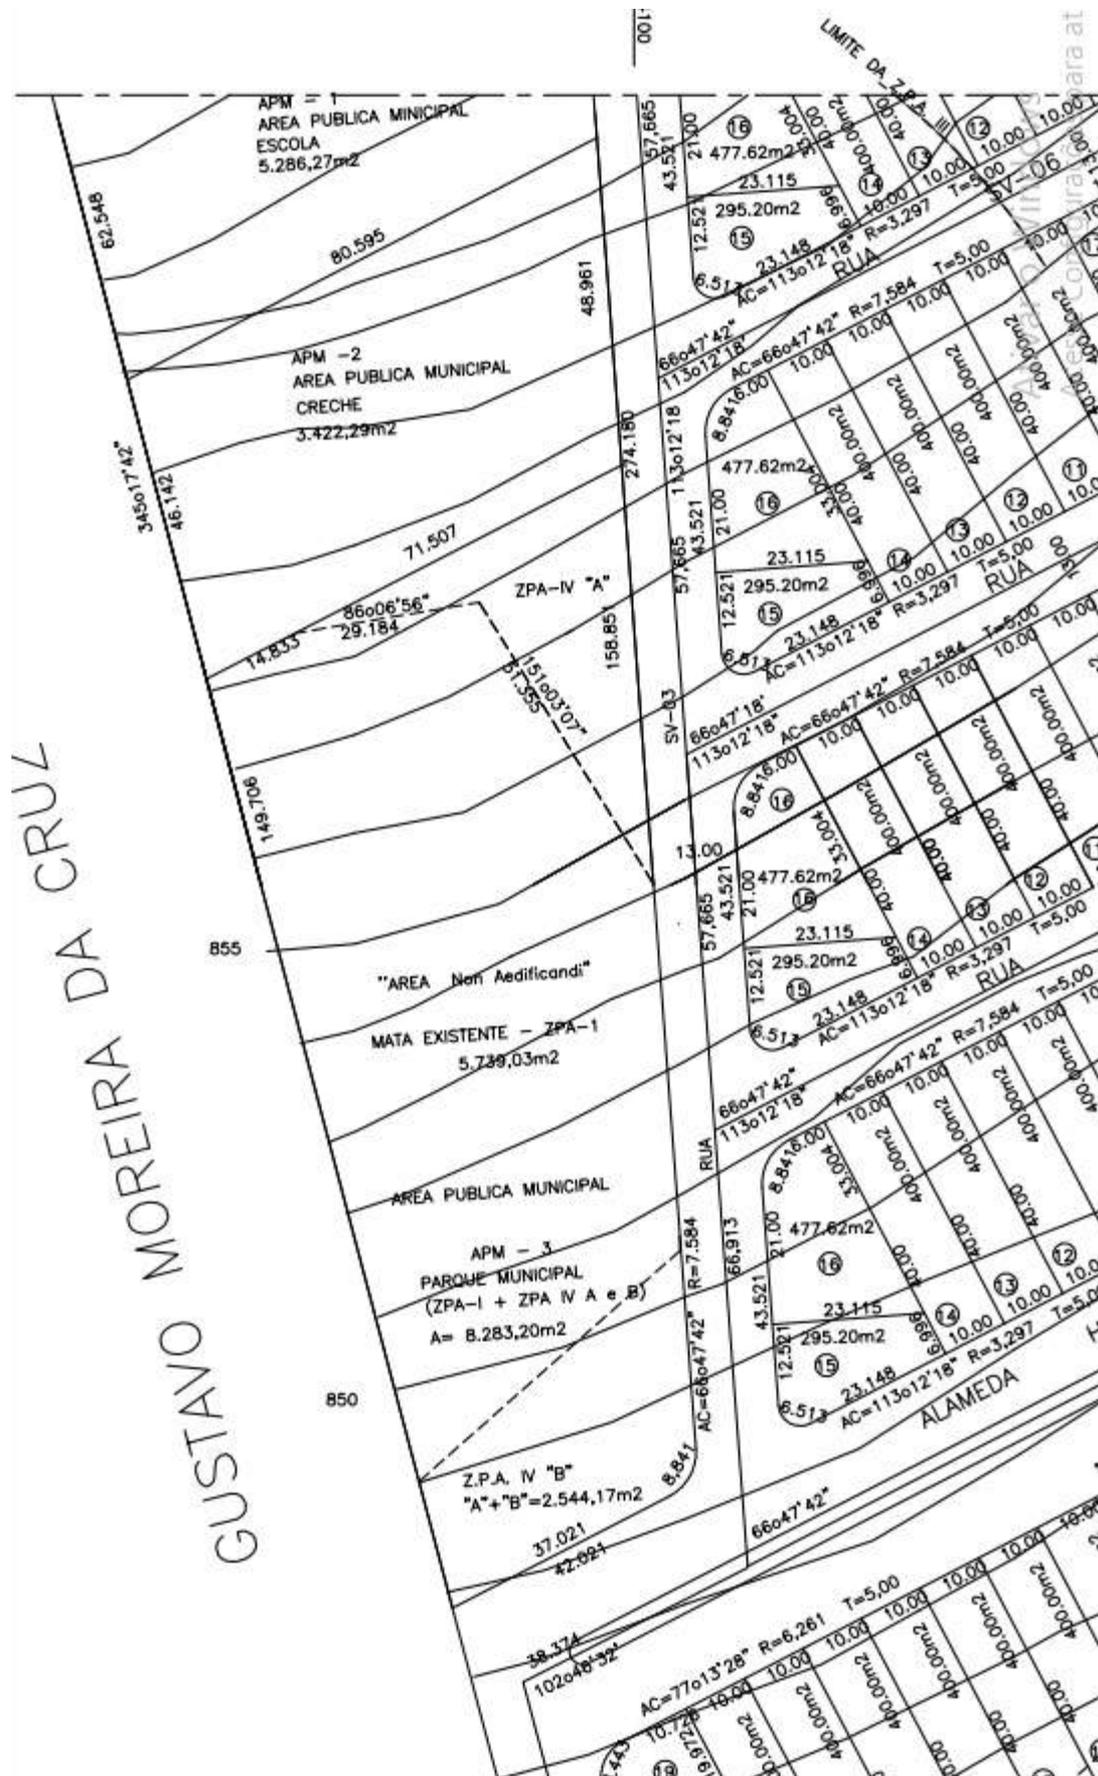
Planta Urbanística parcial do Res. Solar Ville, indicando a localização da APM 3 Fonte: SIGGO.
